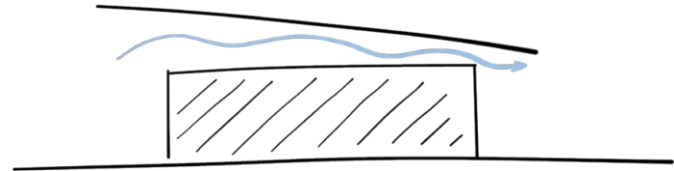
Skizze - Vom Baukörper entkoppeltes Dach
